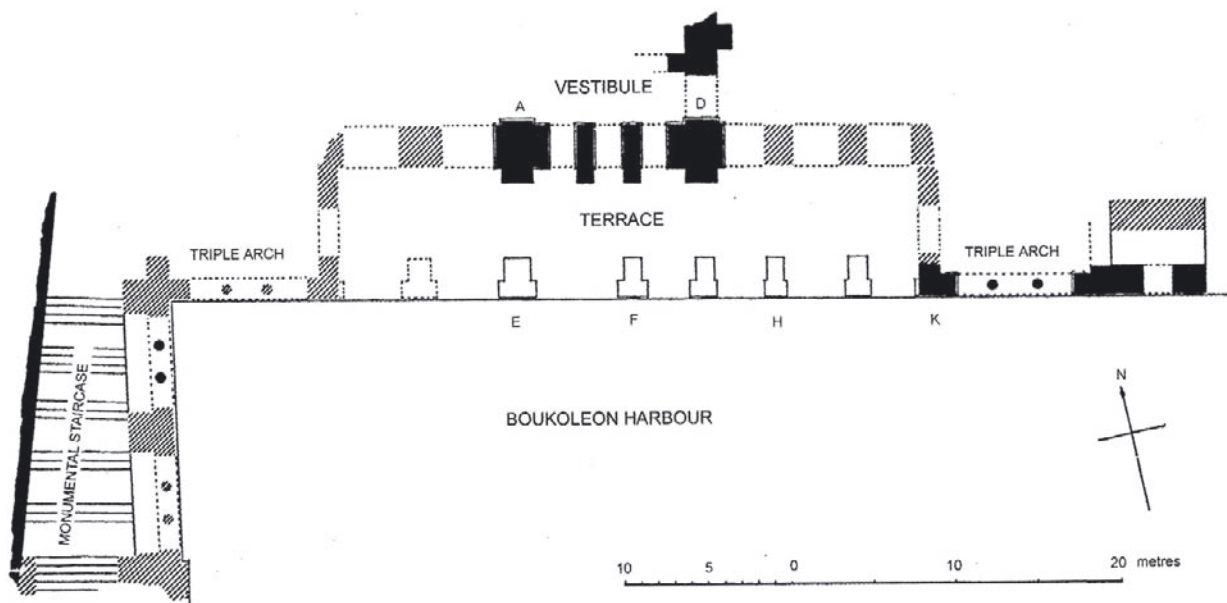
Grundriss des Seepavillons („Haus des Justinian“).
